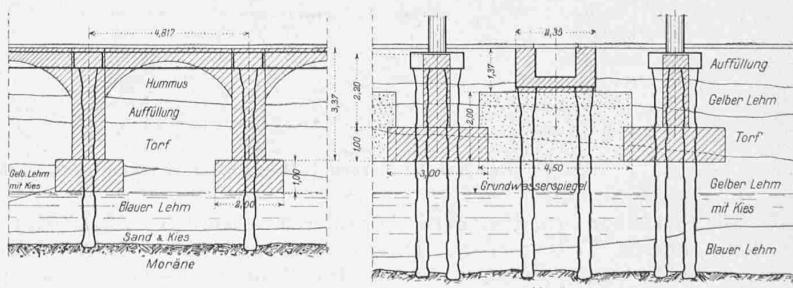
Vergleich der ursprünglich vorgesehenen Fundation (schräffiert) mit der ausgeführten Strausspfahlgründung. — Masstab 1:200.
